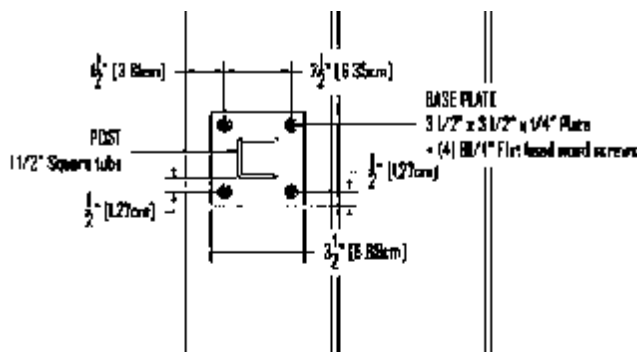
(Izquierda). Detalle del base plate para railings y guardrails (elementos de protección) en donde se muestran las distancias mínimas requeridas para la sujeción a estructuras de madera.
